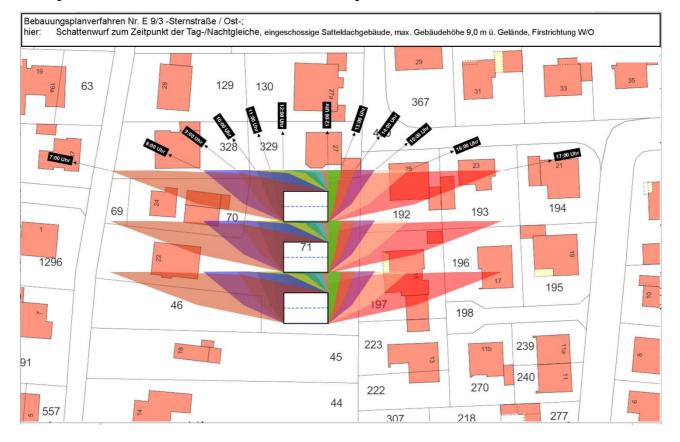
Schattenwurf für Gebäude in den WR-Bereichen mit Firstrichtung W/O
